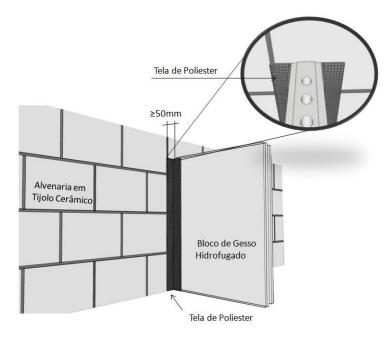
Detalhe do encontro entre a vedação em bloco de gesso e vedação convencional.
